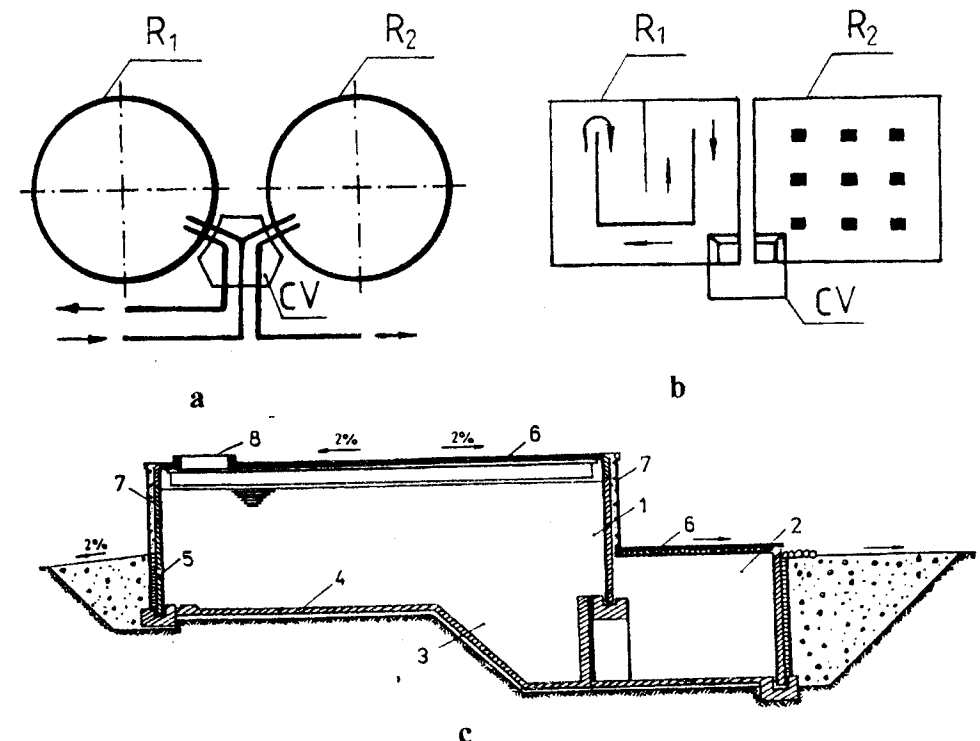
Elementele constructive la rezervoare: a – două rezervoare cuplate în paralel; b - secțiune transversală; 1 - cuva; 2- camera vanelor; 3 –bașă; 4 – radier; 5 – peretele cuvei; 6 – placă prefabricată; 7 – protecție termică; 8 – acces.
